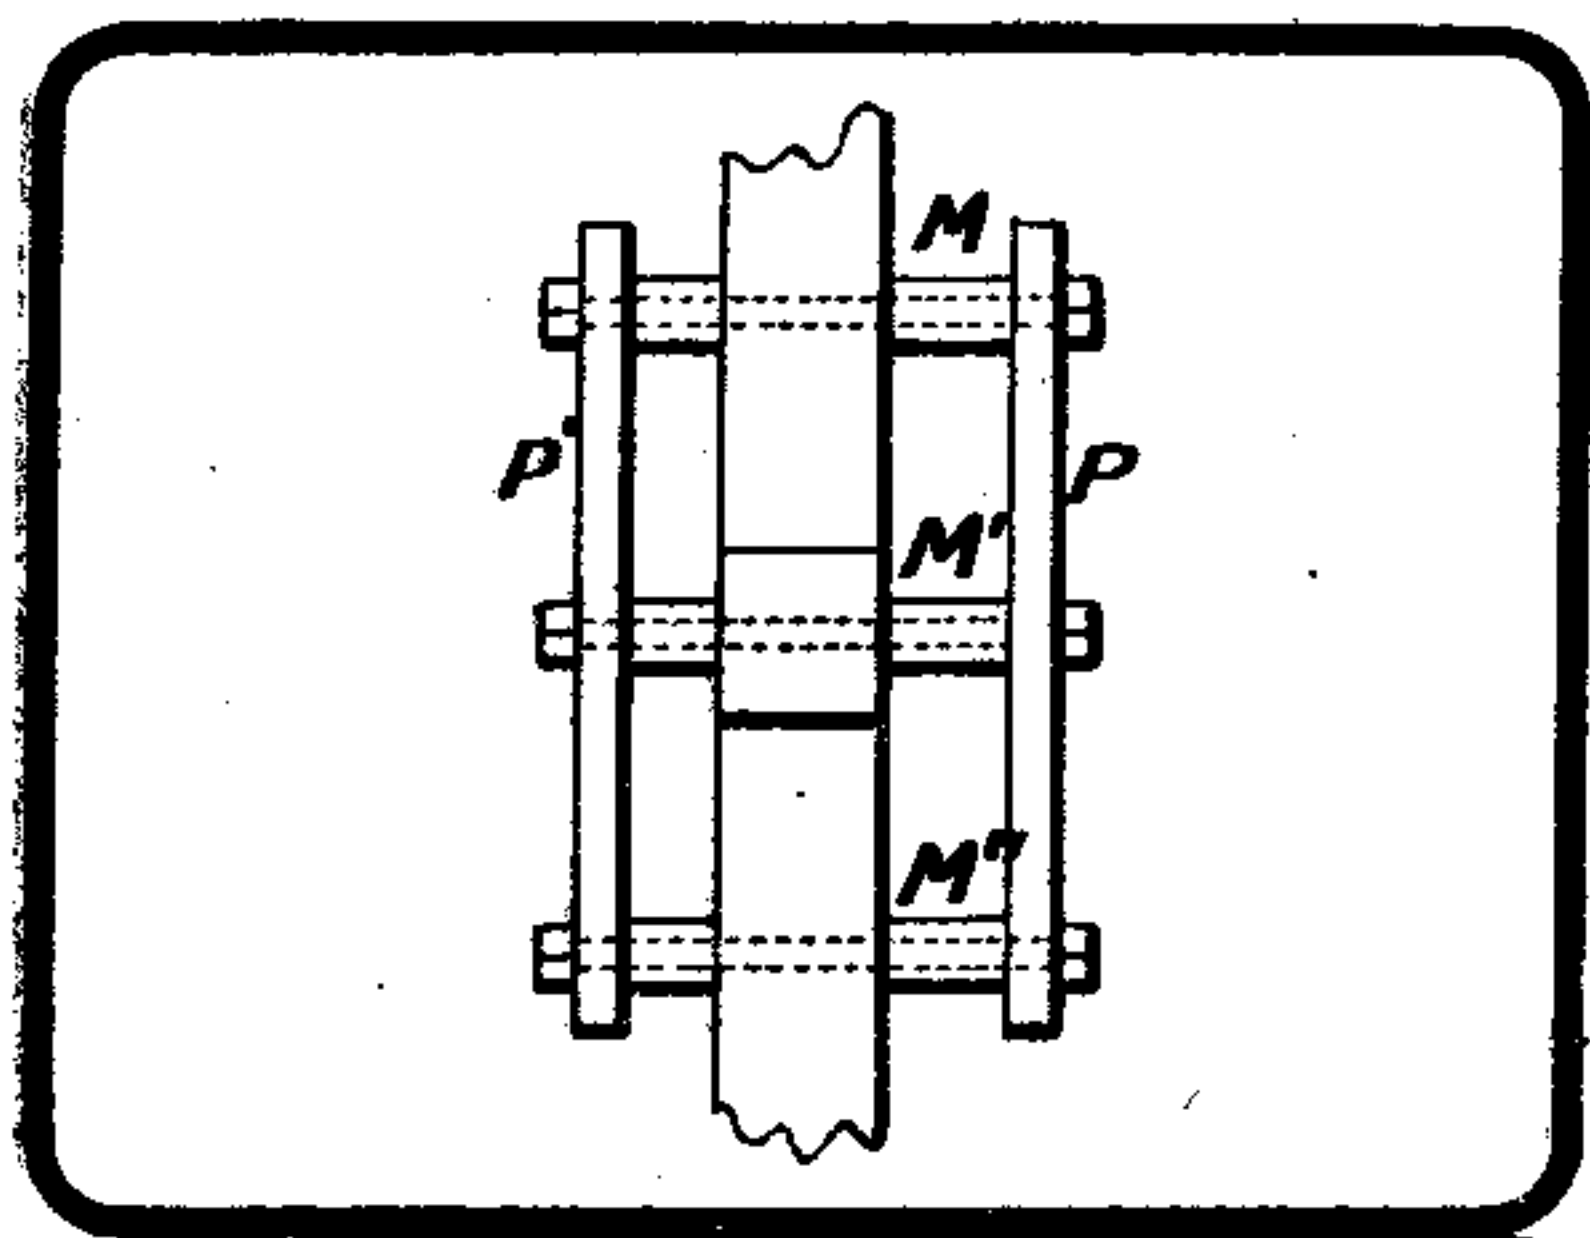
Vue latérale de la plaquette fixée au centre du cadre. P est la plaquette, P' la contre-plaquette.
